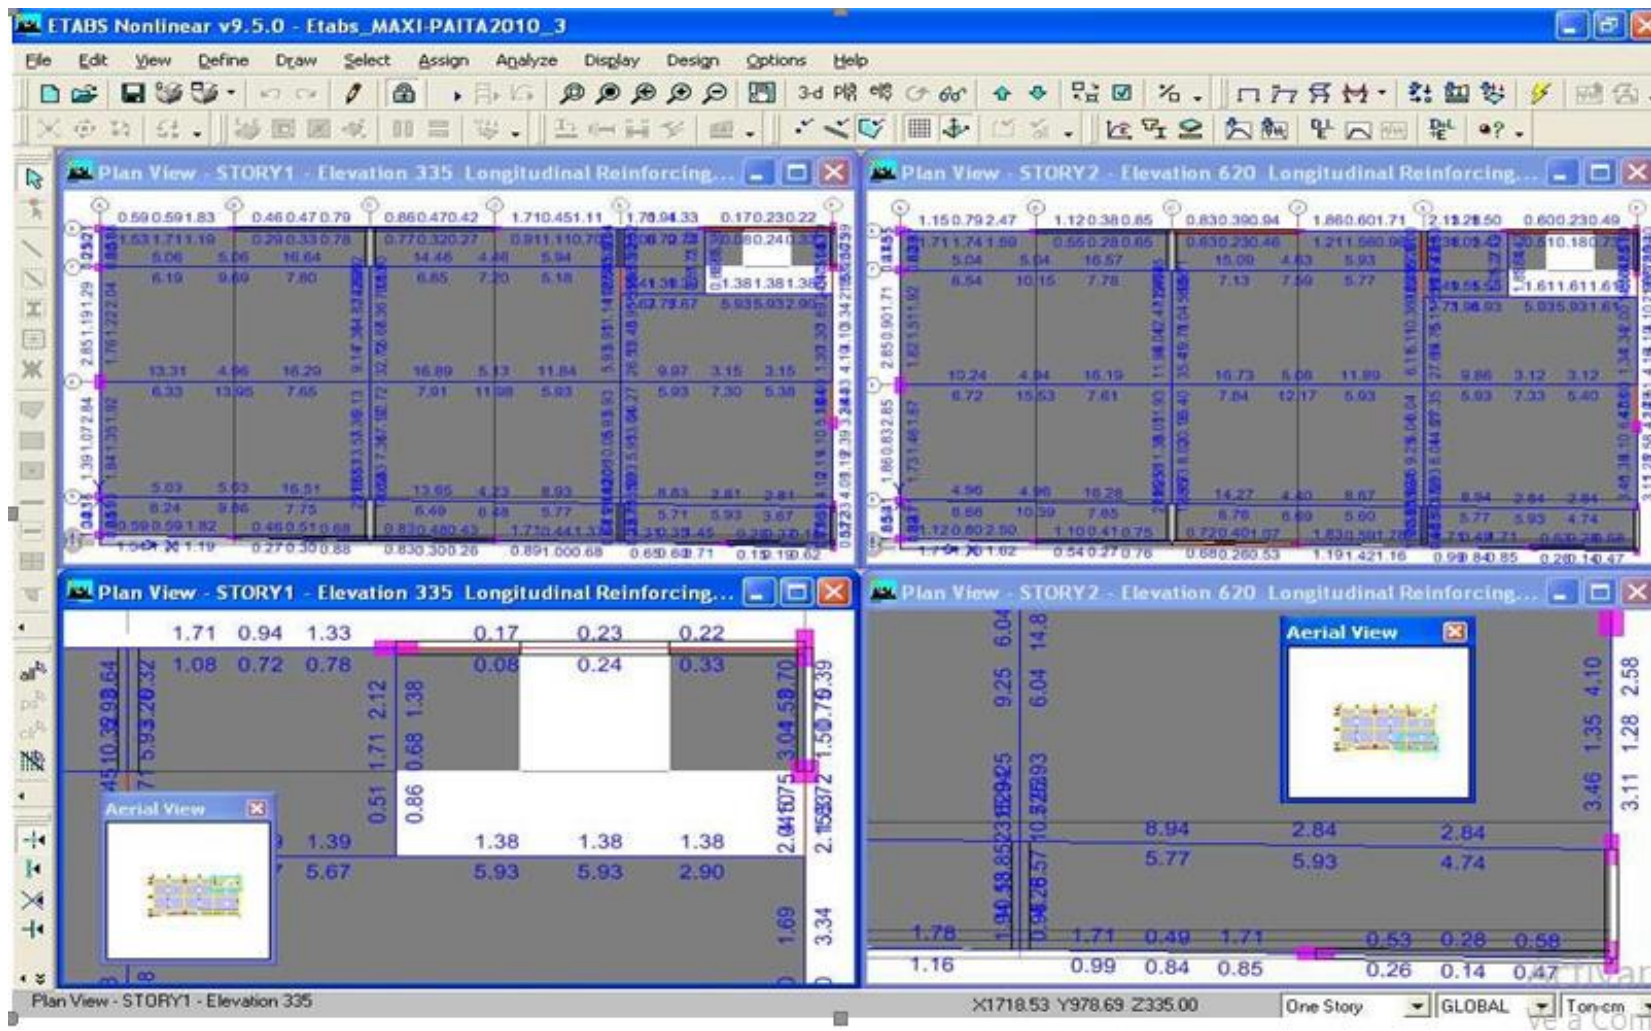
Diseño de refuerzo longitudinal, vista en planta.
